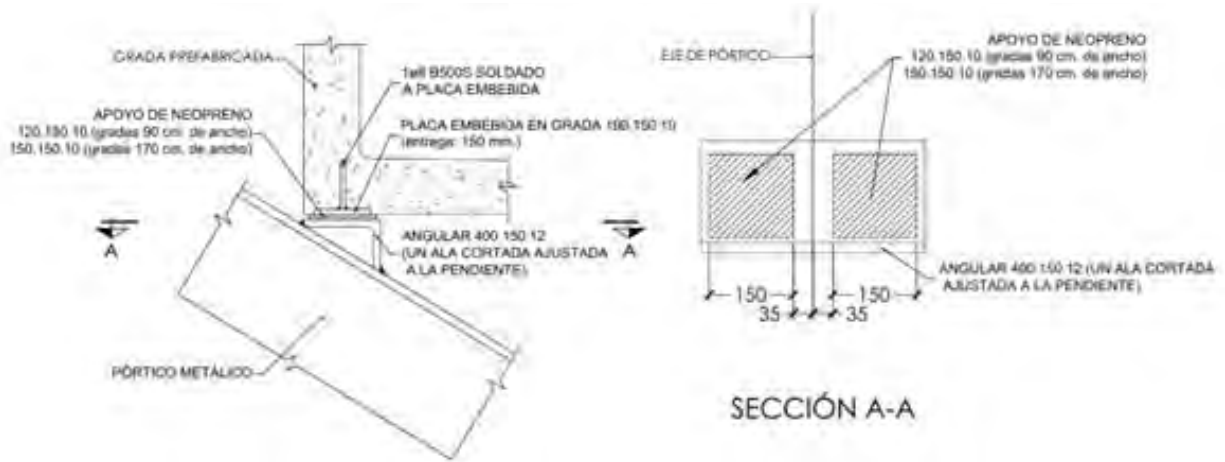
Detalle de apoyo de gradas prefabricadas sobre vigas portagrada.
